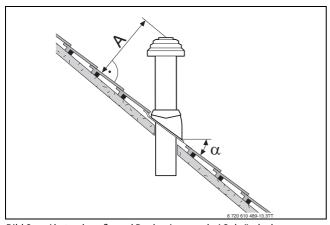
Abstandsmaße und Dachneigungen bei Schrägdach
